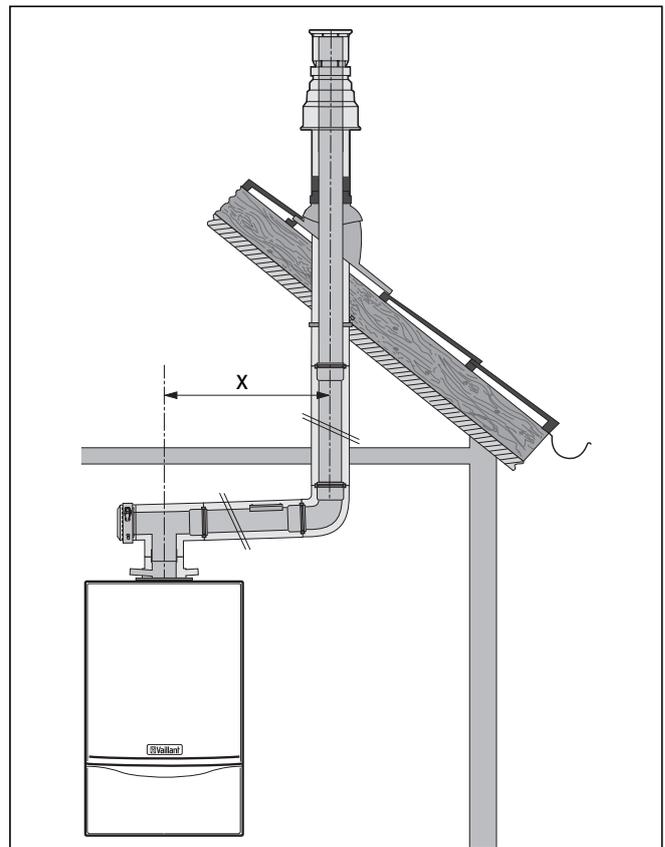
Montagebeispiel: Senkrechte Dachdurchführung
